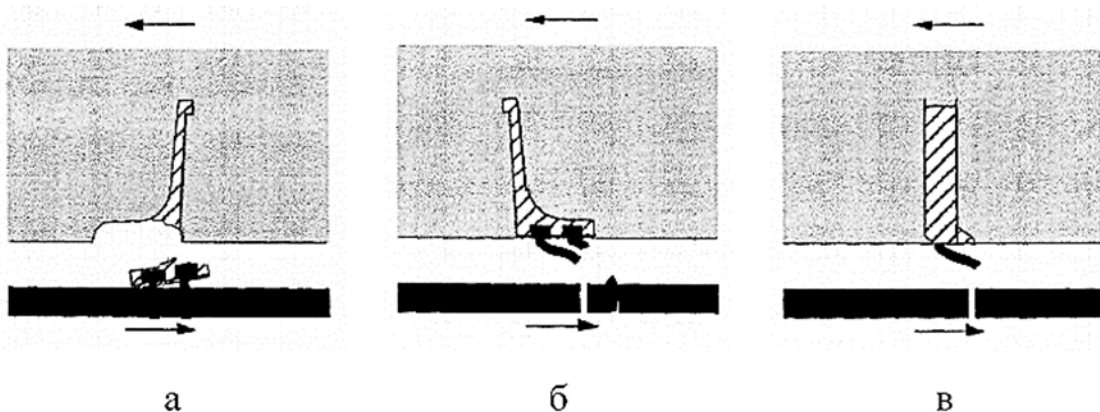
Найбільш характерні механізми руйнування анкерних в'язів в сталезалізобетонних балках. а - зріз анкерного упору; б - вилив з бетону зі зрізом ребра; в - продавлювання бетонного ребра
